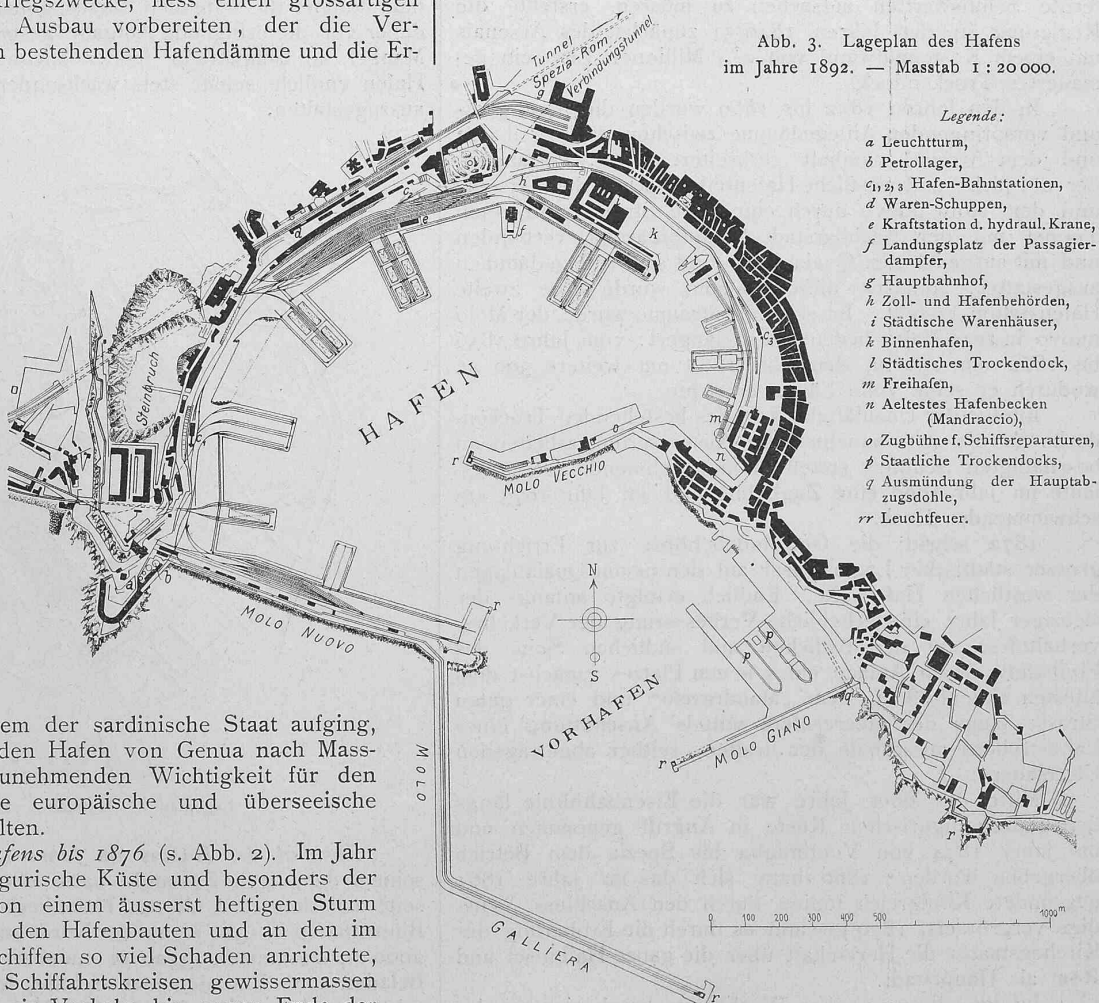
Lageplan des Hafens im Jahre 1892. — Masstab 1 : 20 000.
